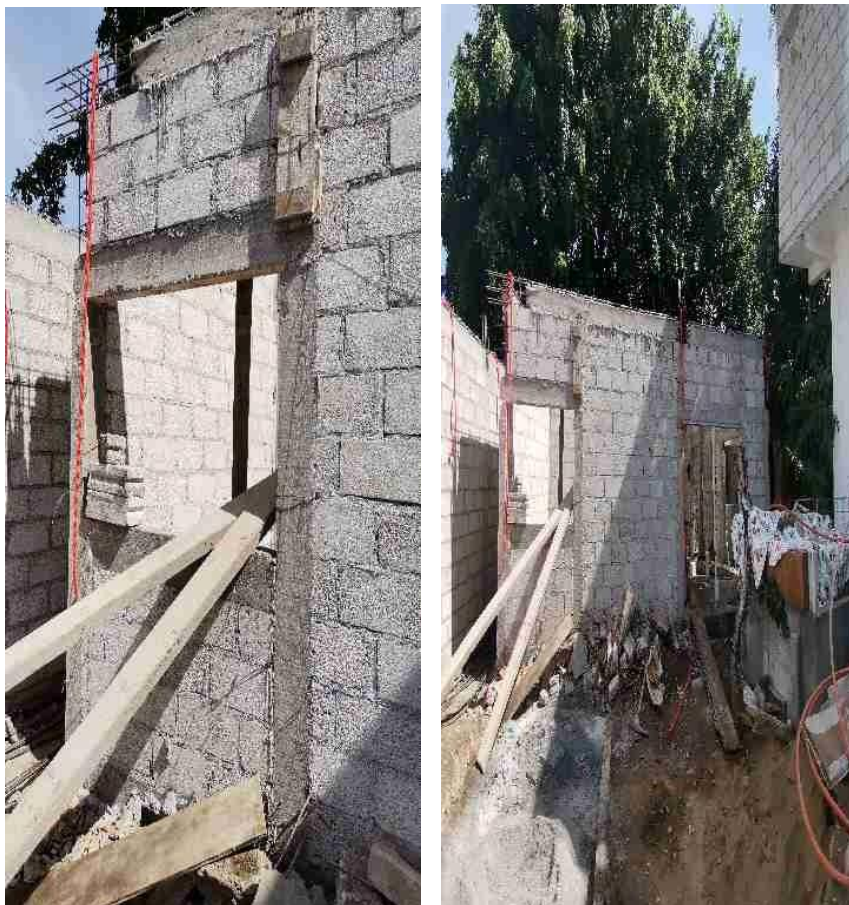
Exterior de la casa. (18.952114, -98.979683).
